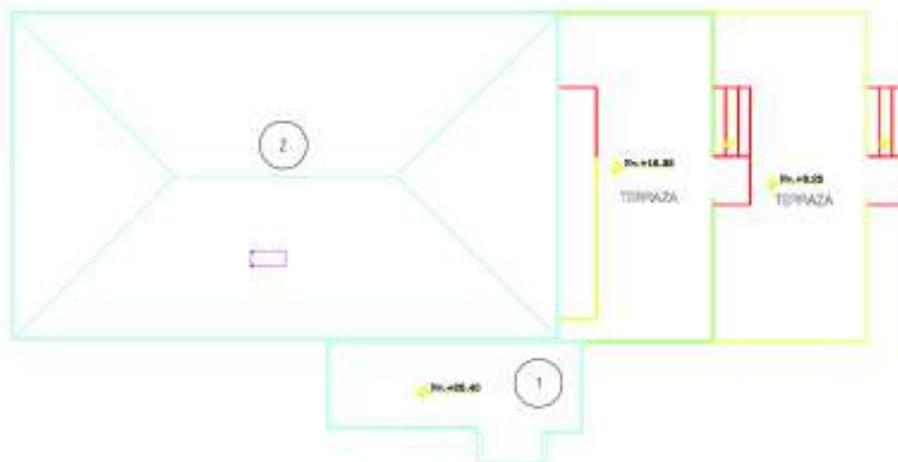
Distribución EARME primera etapa, Planta Cubiertas
